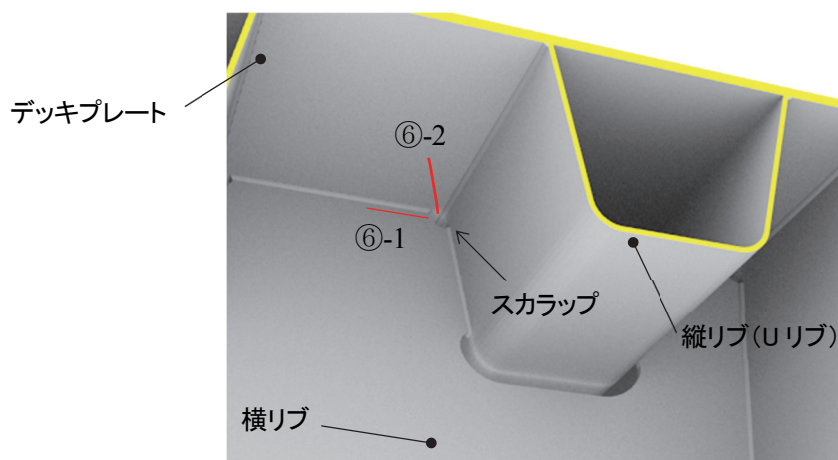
デッキプレート-縦リブ 溶接部の損傷タイプ
